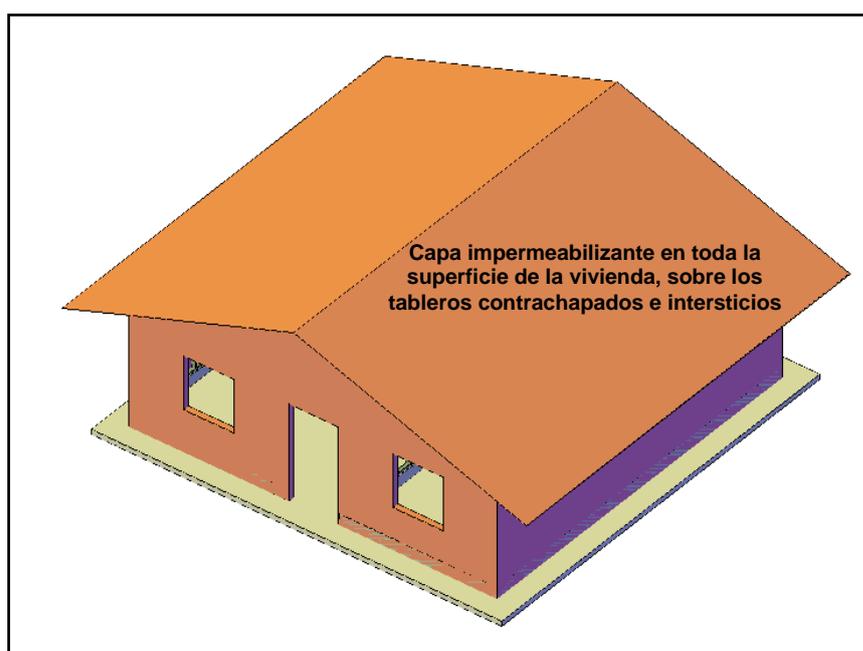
Capa impermeabilizante en toda la superficie de la vivienda.
